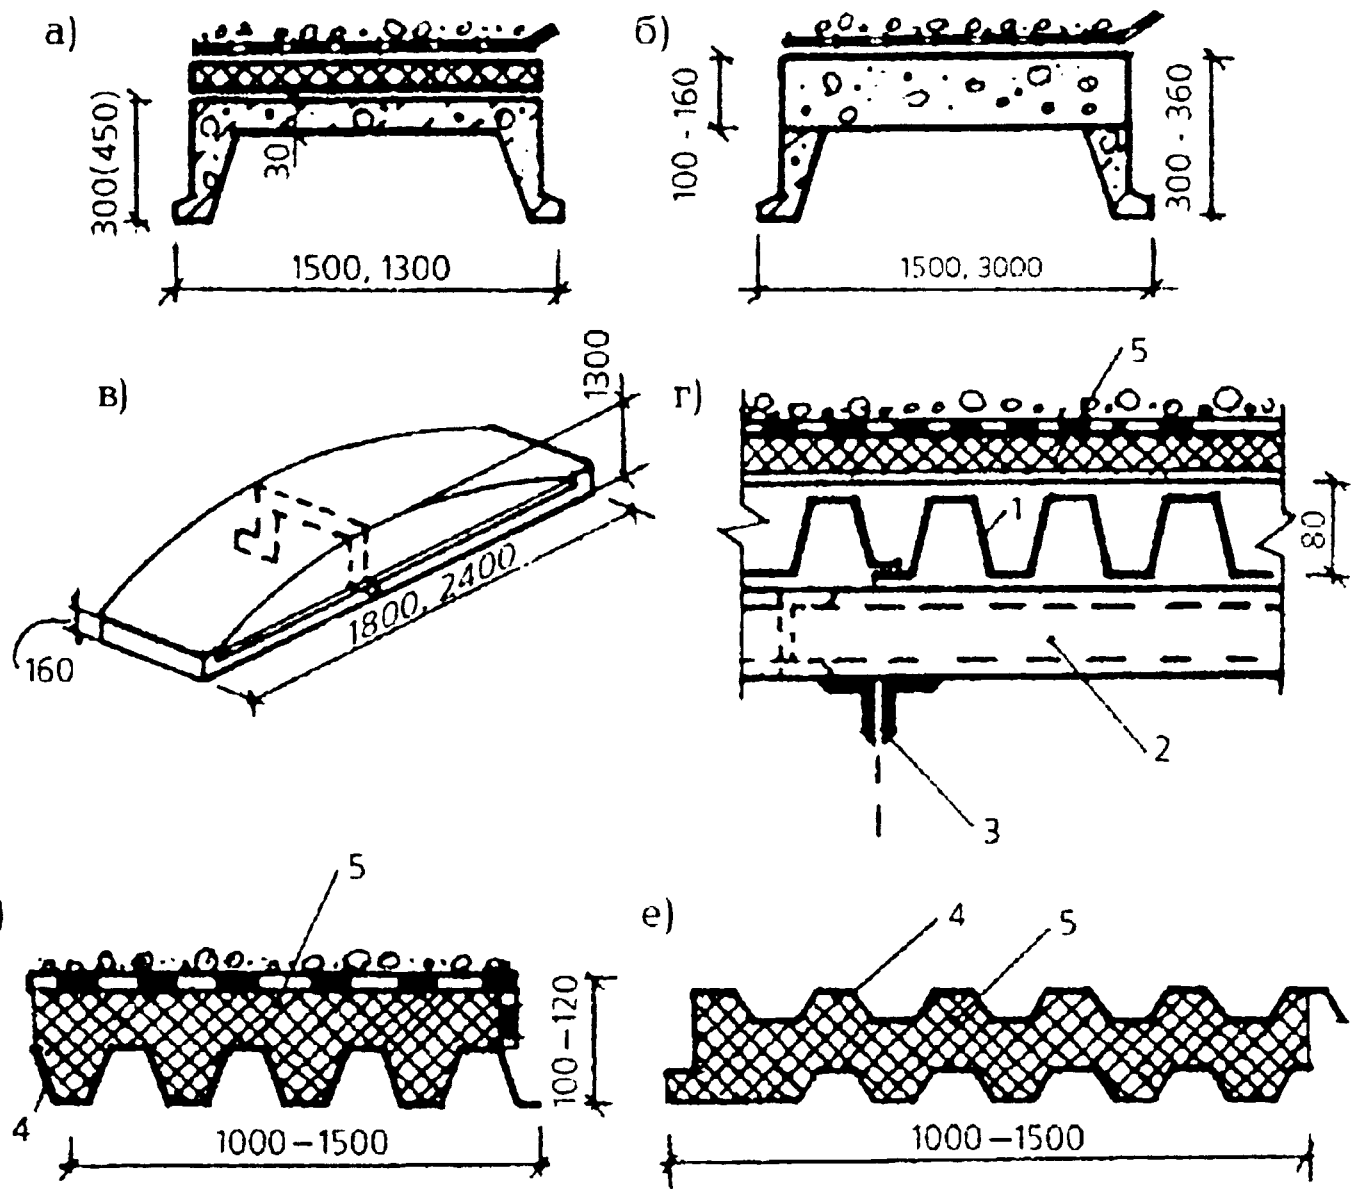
Совмещенные покрытия по бетонным плитам (настилам) и на основе металлического профилированного листа: а - утепленное покрытие по железобетонным ребристым панелям; б - утепленное покрытие с использованием комплексных панелей; в - длиномерный настил типа КЖС; г - утепленное прогонное покрытие по стальному профилированному листу; д - монопанель; е - трехслойная панель с утеплителем из пенополиуретана; 1 - стальной профилированный настил; 2 - стальной прогон; 3 - стропильная ферма покрытия; 4 - стальной профилированный лист; 5 - утеплитель
